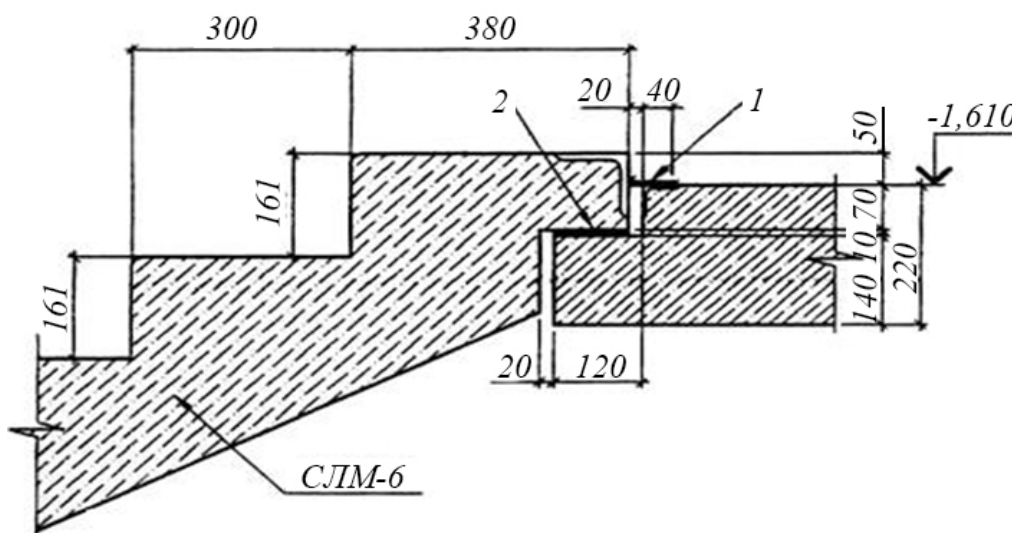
Сопряжение сборного лестничного марша с монолитной лестничной площадкой
